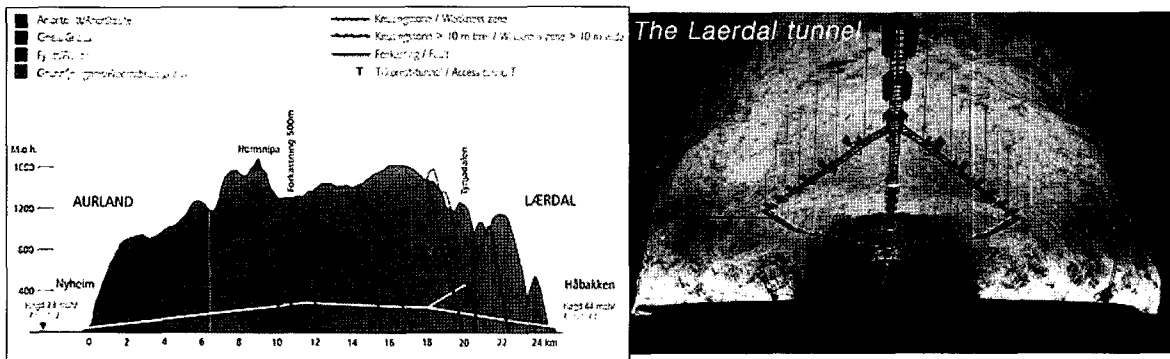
세계 최장대 육상터널(운영중) - Laerdal Tunnel(24.5km)
